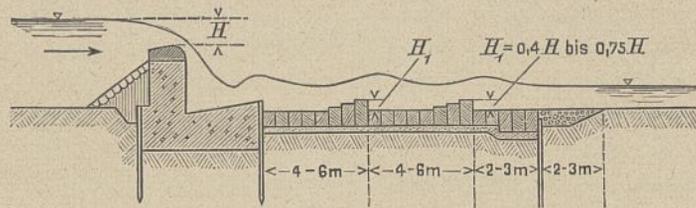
Sturzbett aus Betonprismen mit Stromablenkern.
